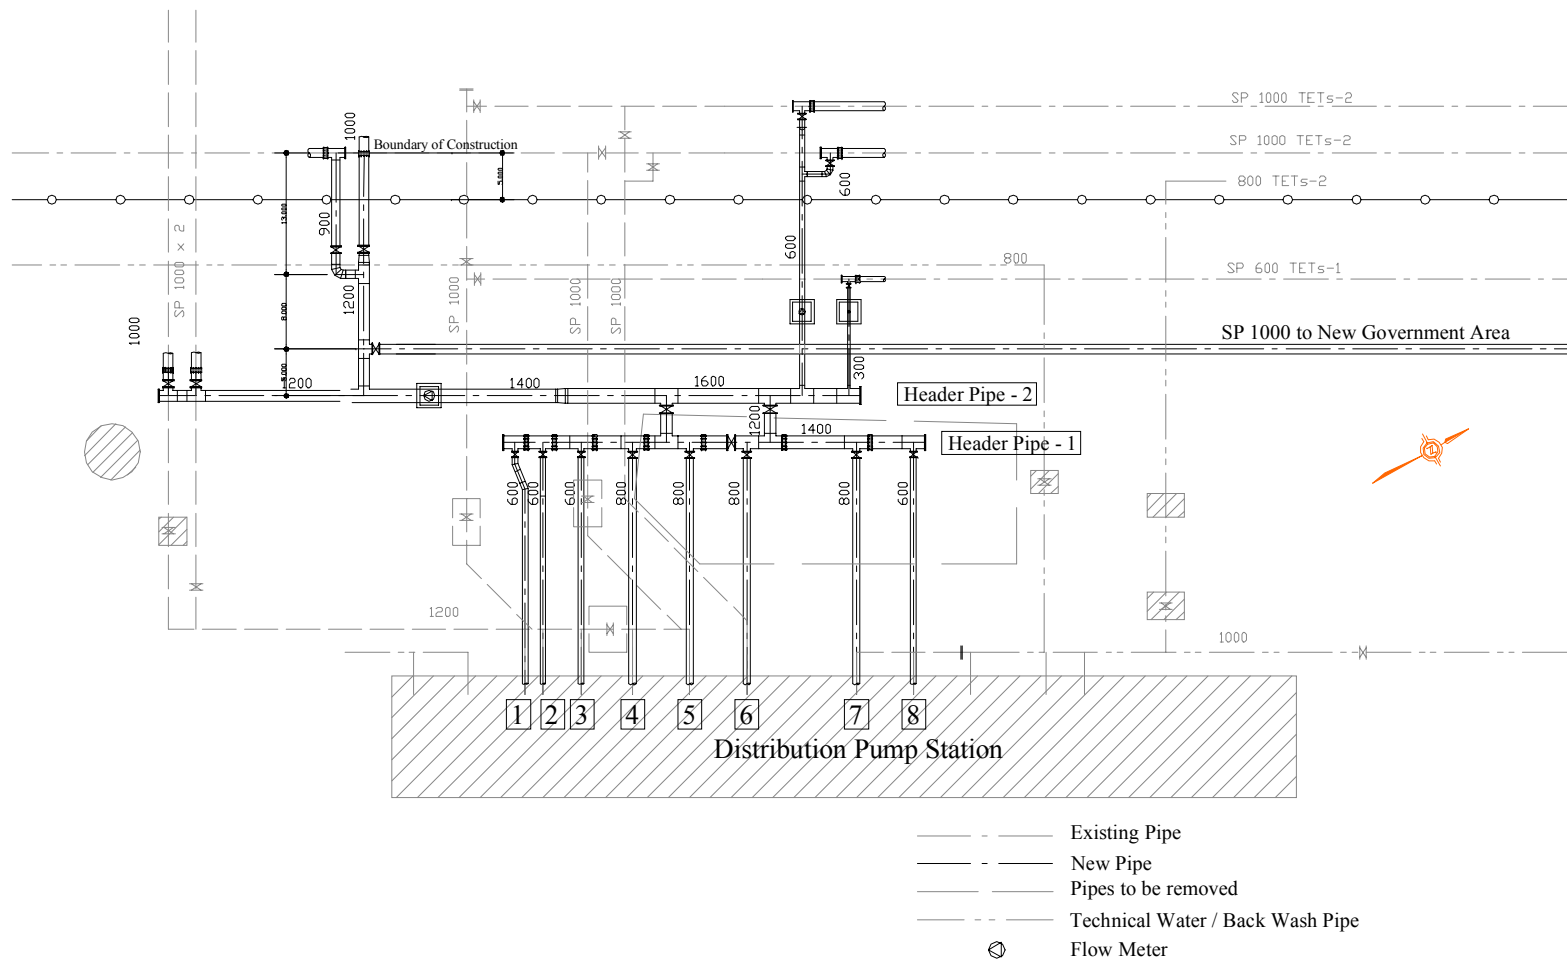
Соединение с распределительными трубопроводами
